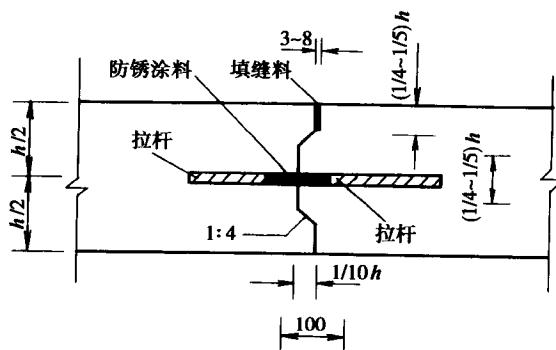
设拉杆企口缝形式的施工缝构造(尺寸单位:mm)
